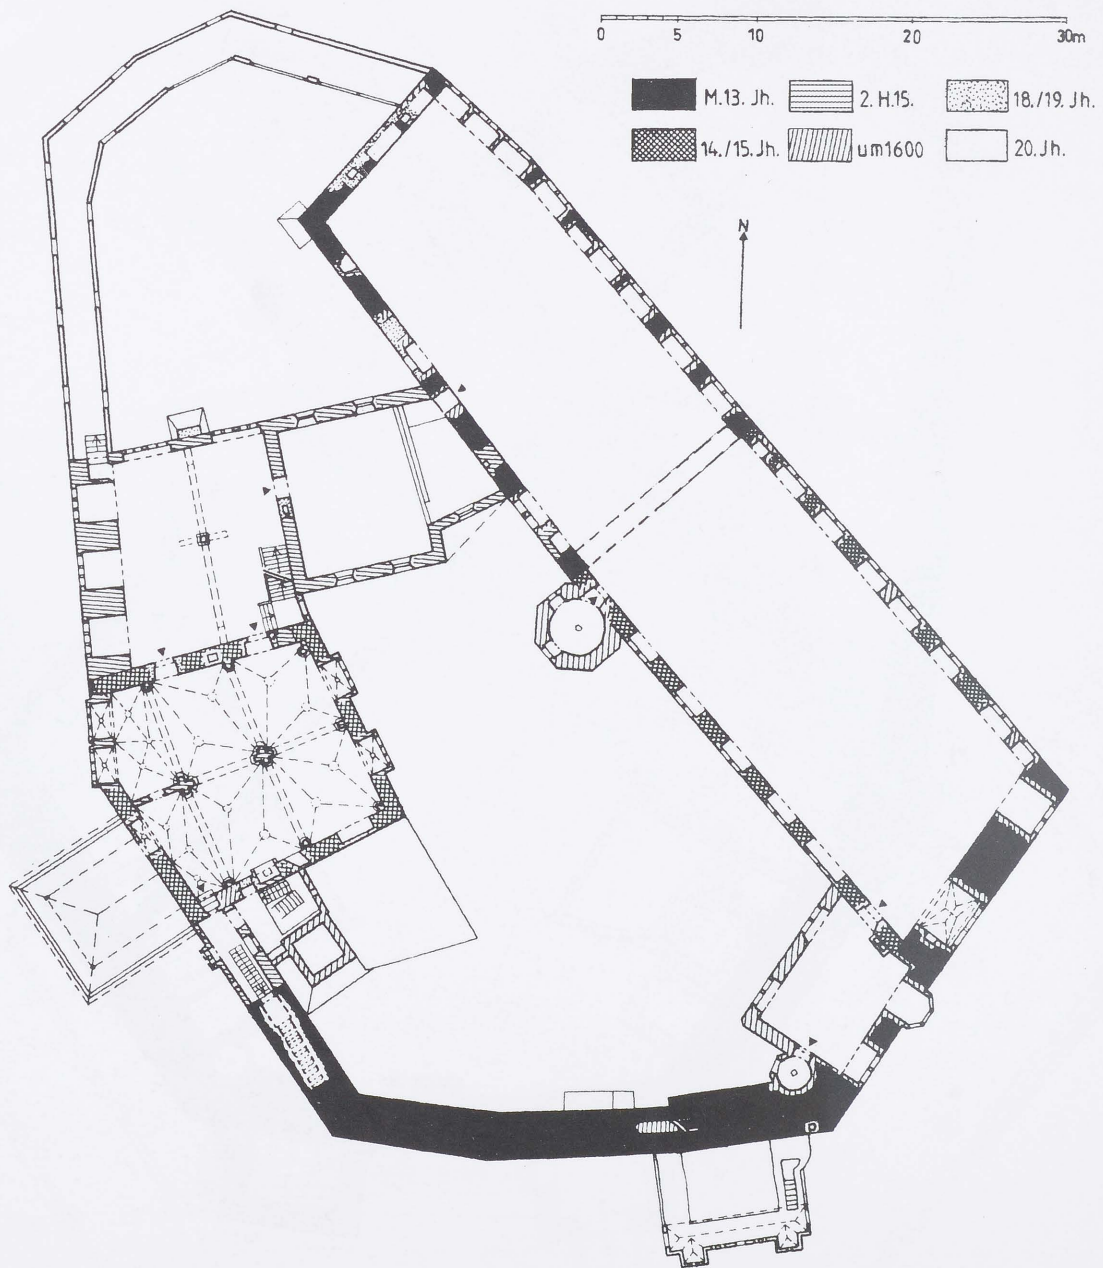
Baulterplan der Kernburg, Erstes Obergeschoß.
